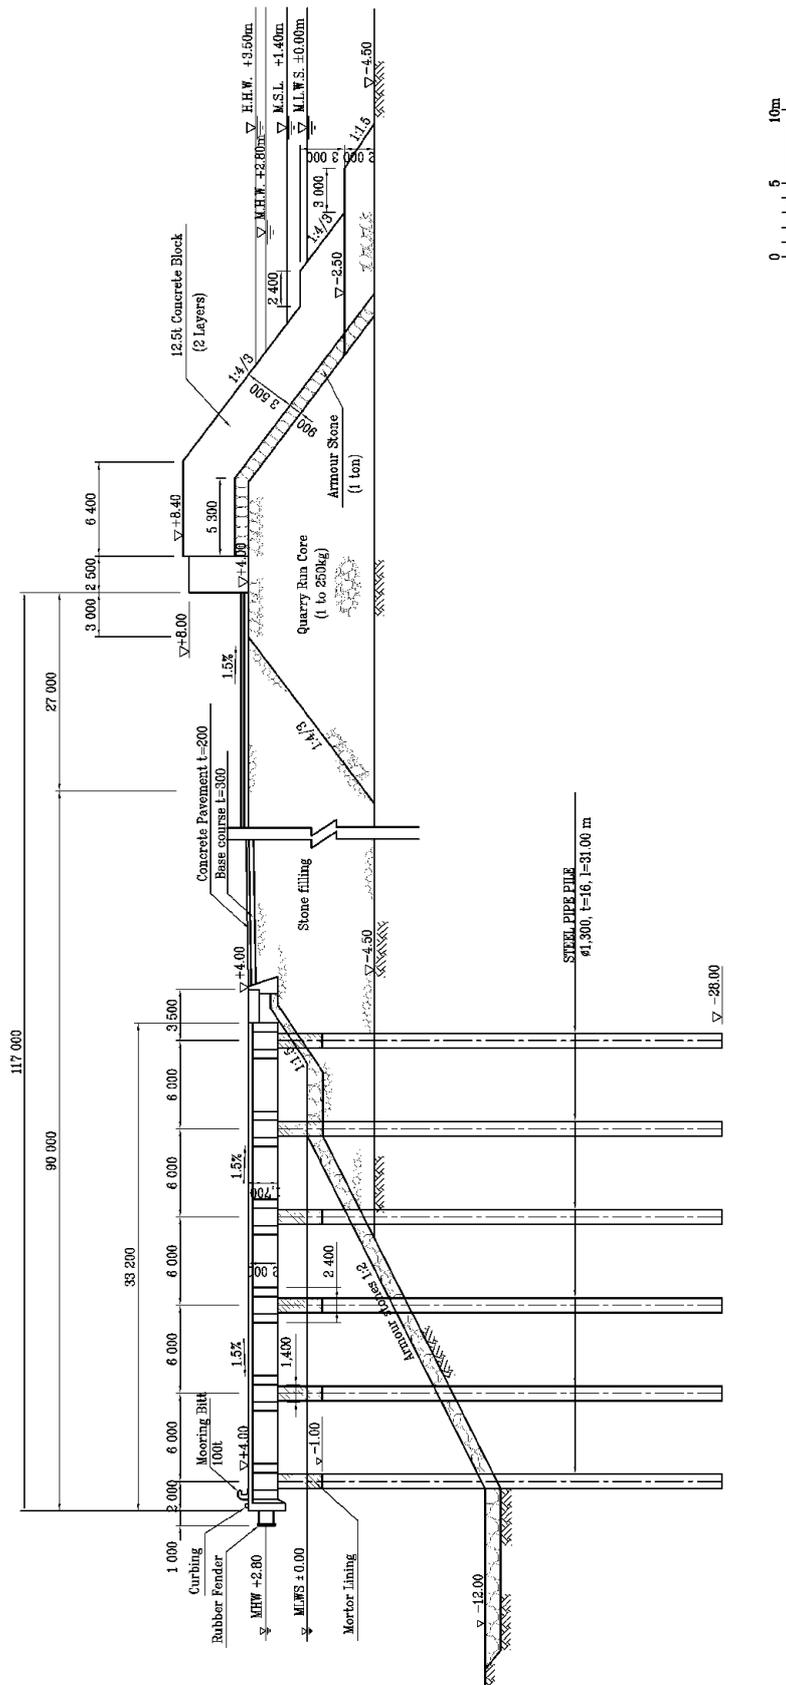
Sección Típica de Atracadero Multi-uso
